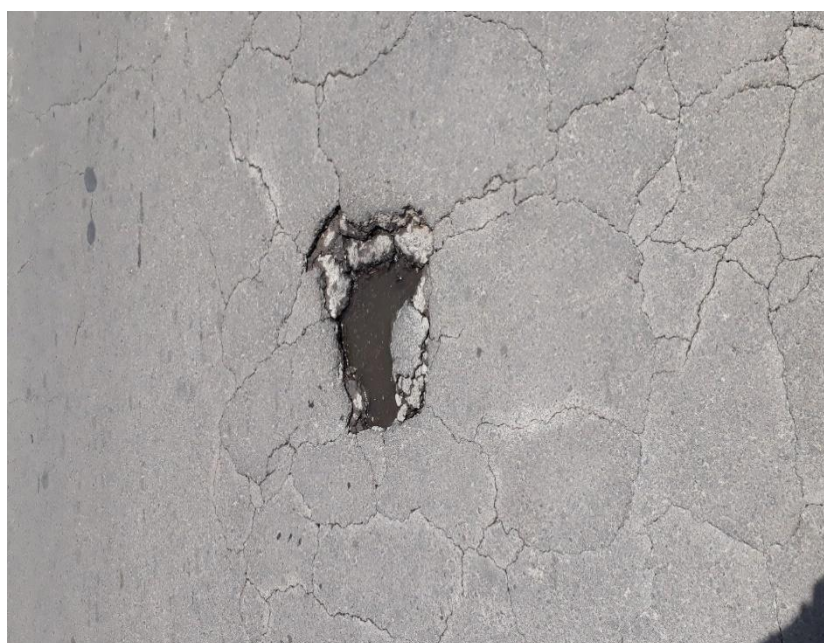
Tipo de Falla Fisuras por Bloque
